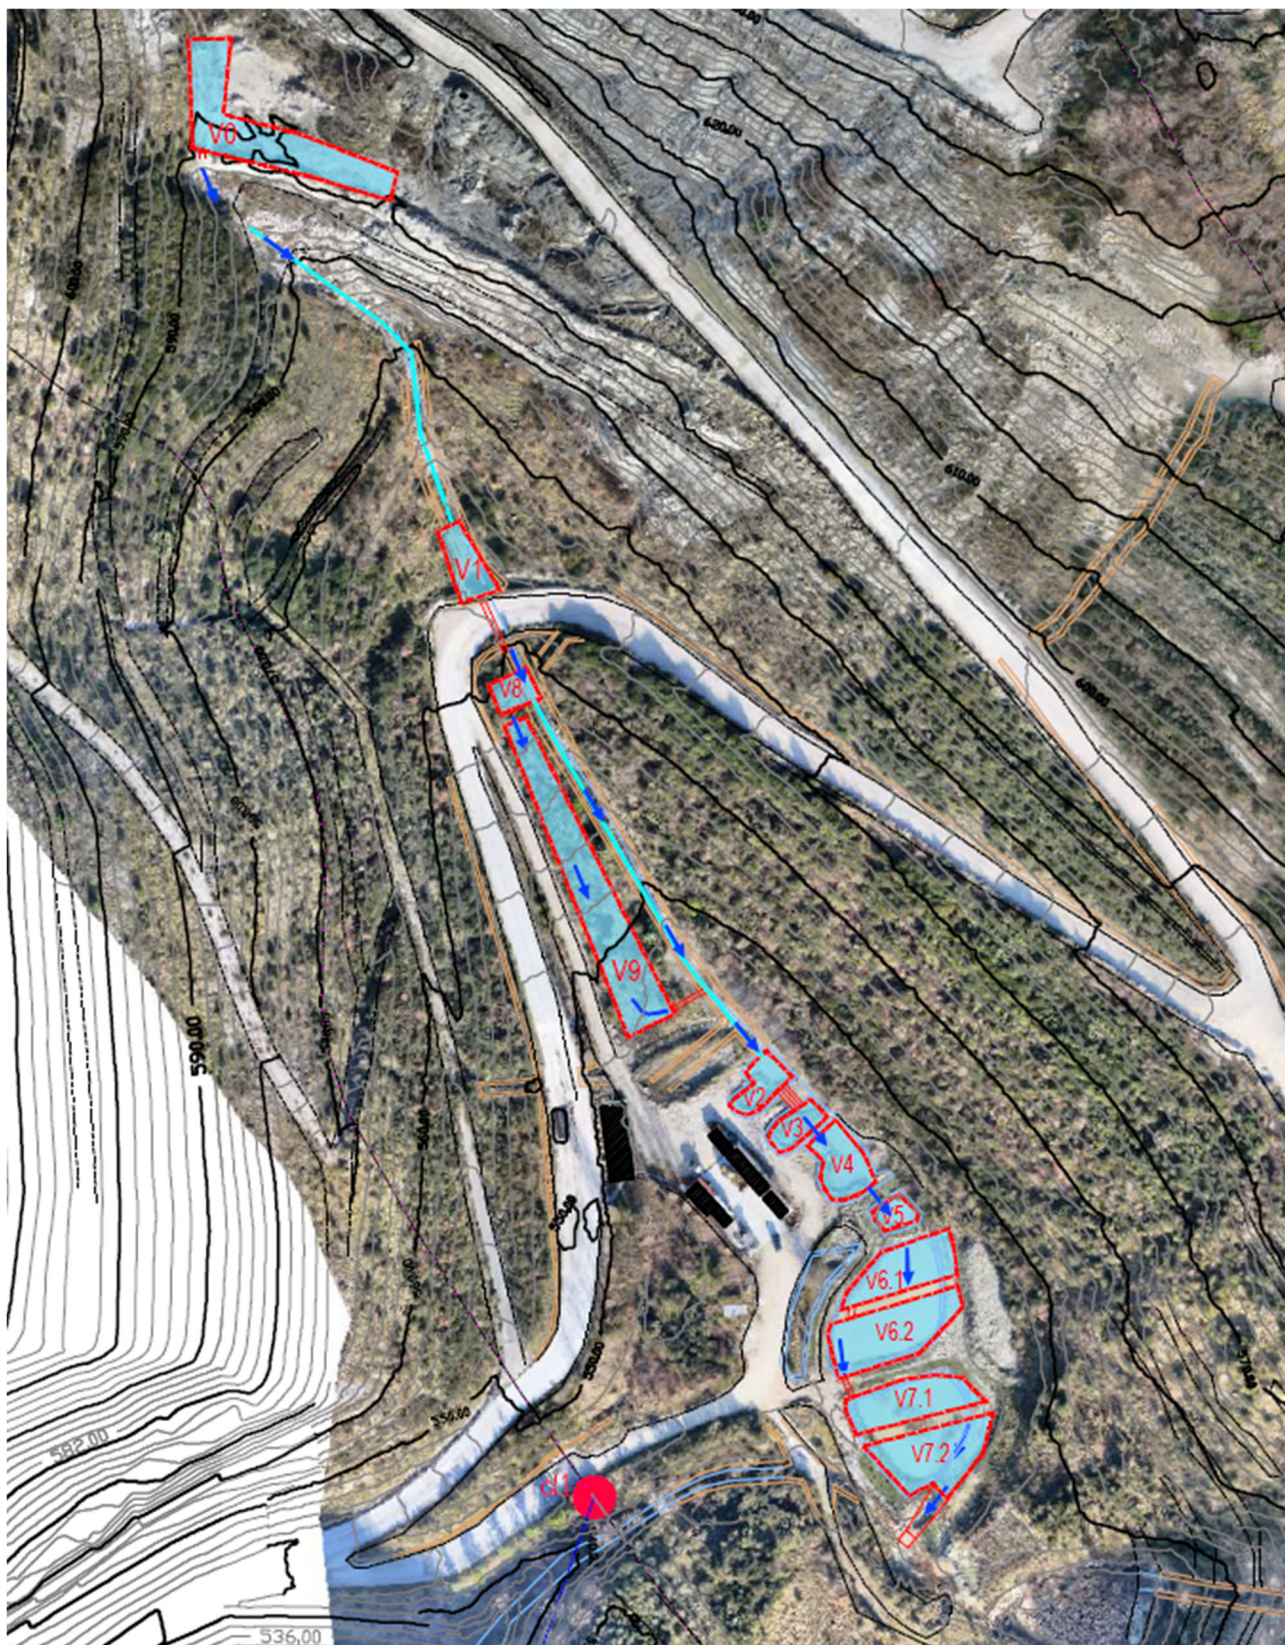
rappresentazione planimetrica delle vasche nella configurazione di progetto
